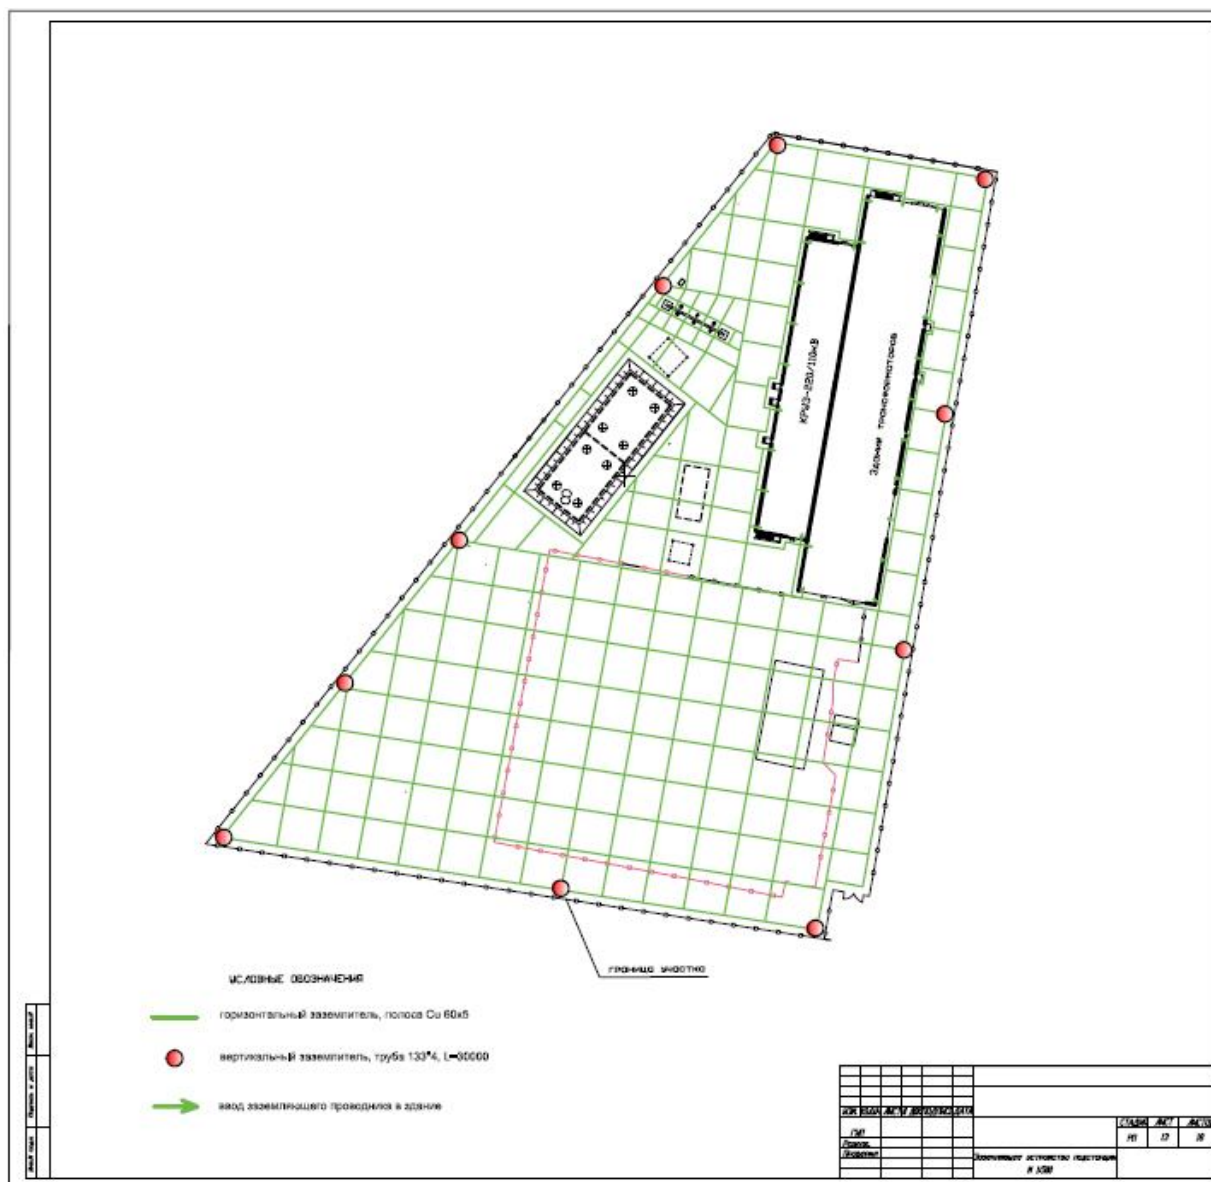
Схема наружного заземляющего устройства закрытой ПС с КРУЭ-220 кВ и КРУЭ-110 кВ, переходным пунктом 220 кВ
